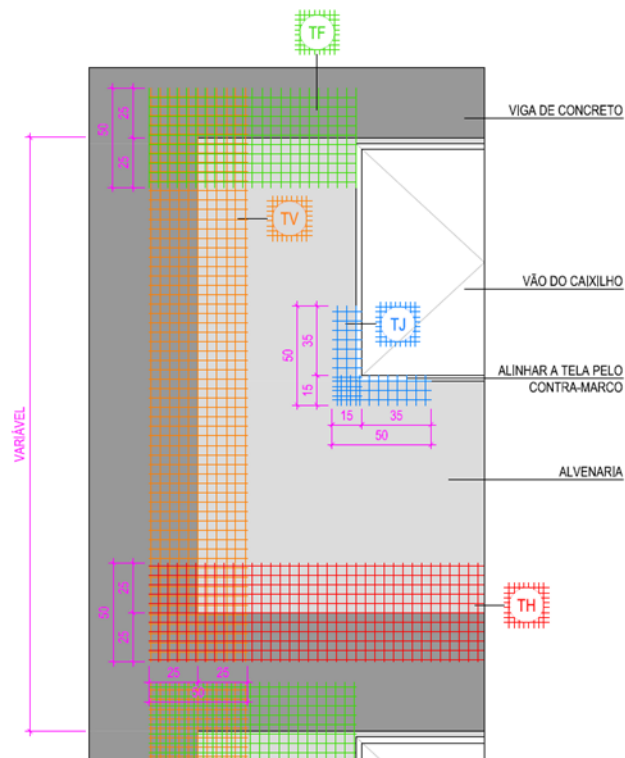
Exemplo de representação de telas de reforço em projeto de revestimento de fachada
